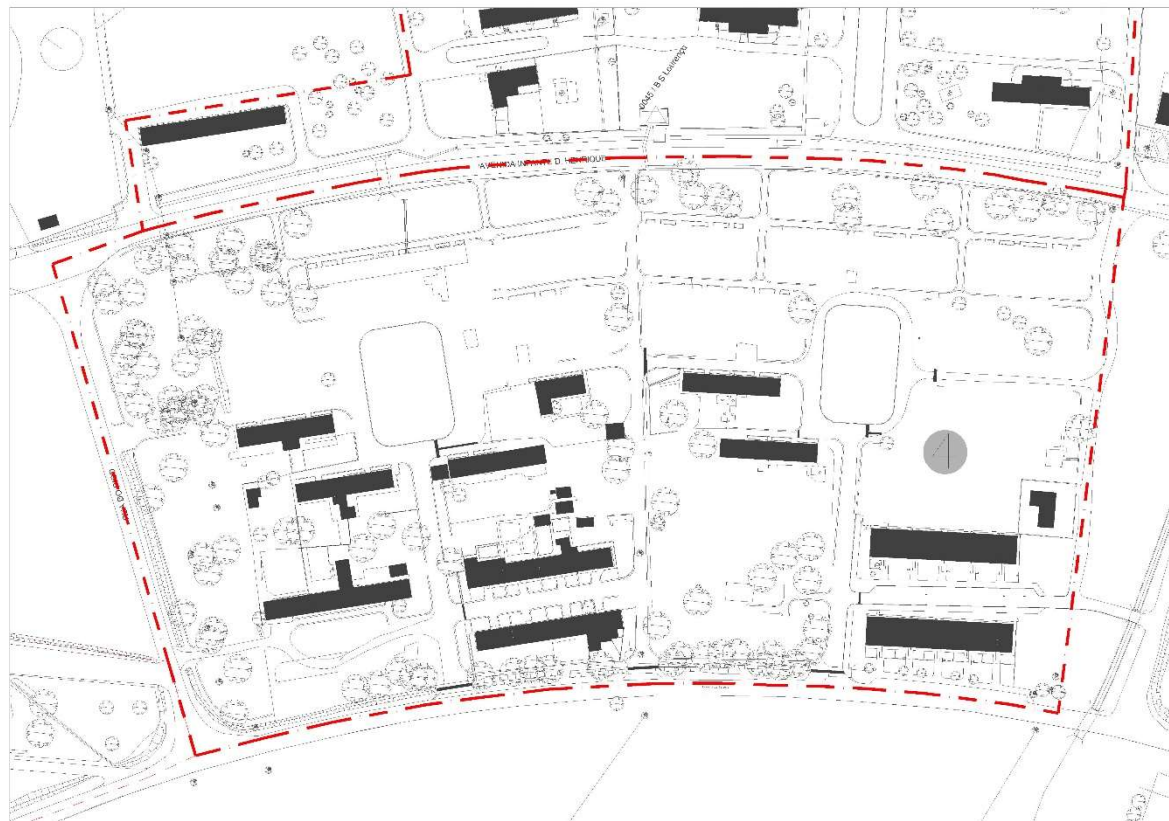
Planta do Bairro Santa Bárbara (Extrato de Planta Cedida Pelas Ilhas de Valor)
